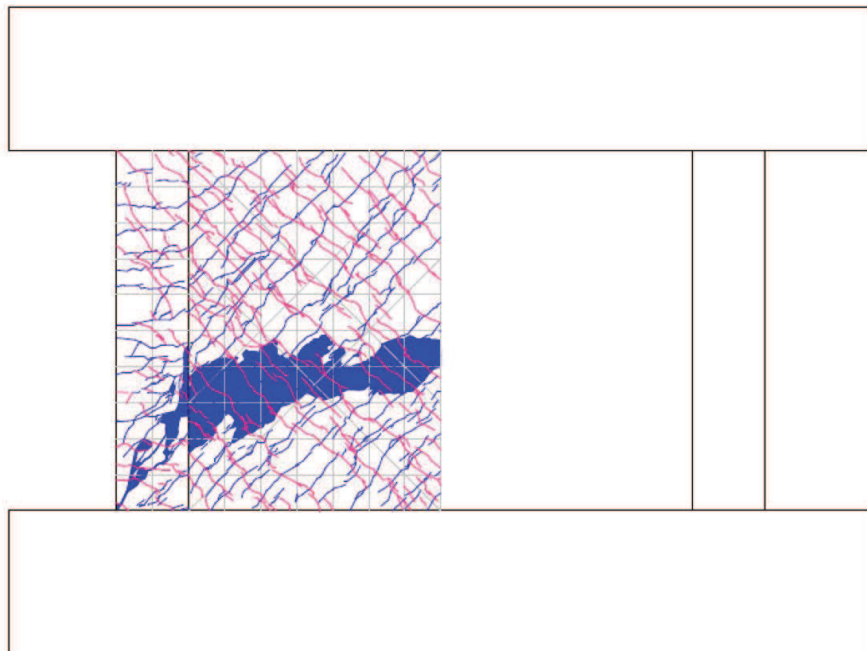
試験体 S-13-DIV 最終破壊時ひび割れ図
